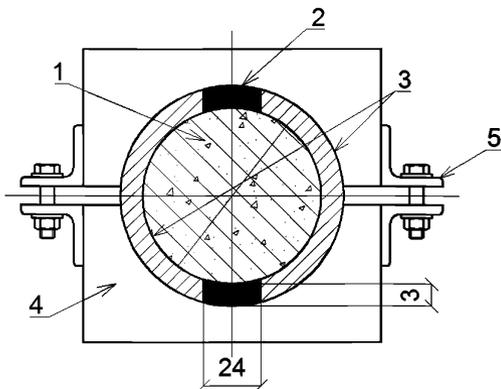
Схема устройства подливки вдоль керна по двум образующим с помощью кондуктора:
